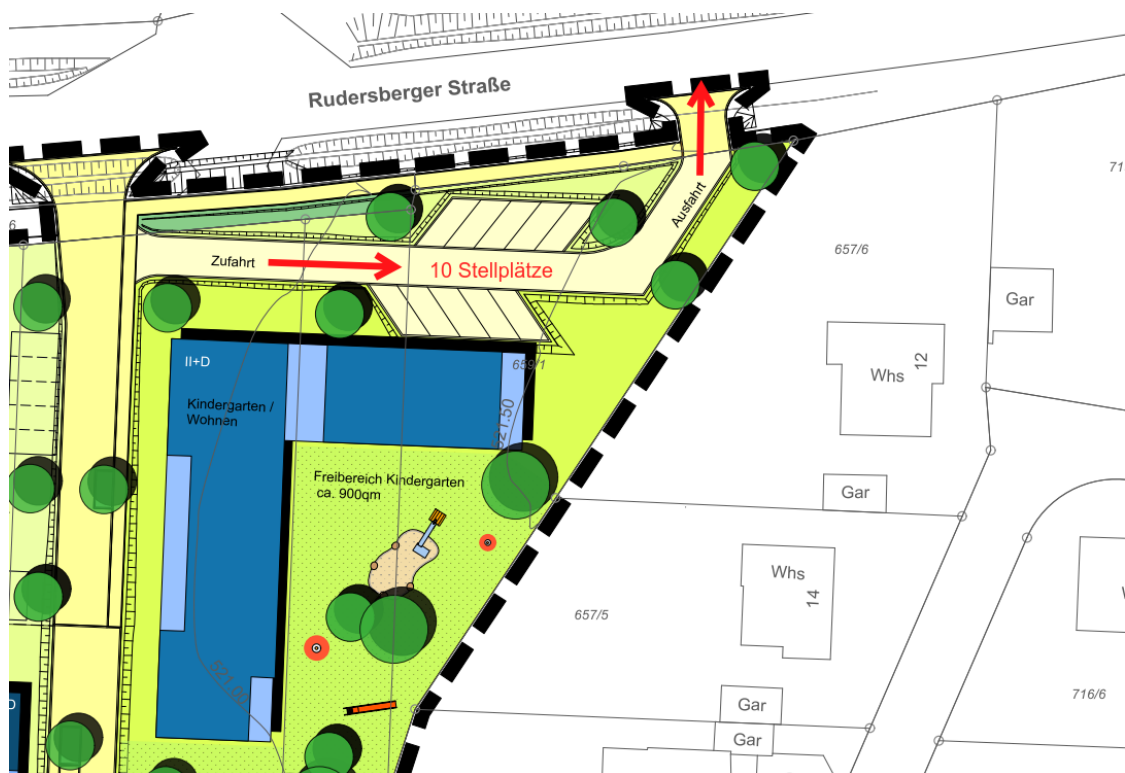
Ausschnitt aus dem Entwurf des BP „Erdgrube“ [16]
